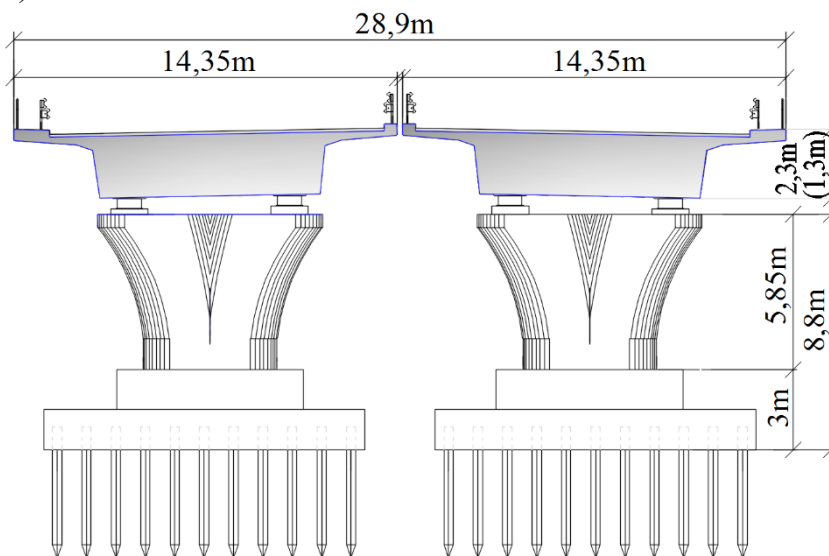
Вариант балочно-неразрезной схемы с индивидуальными пролетными строениями:
